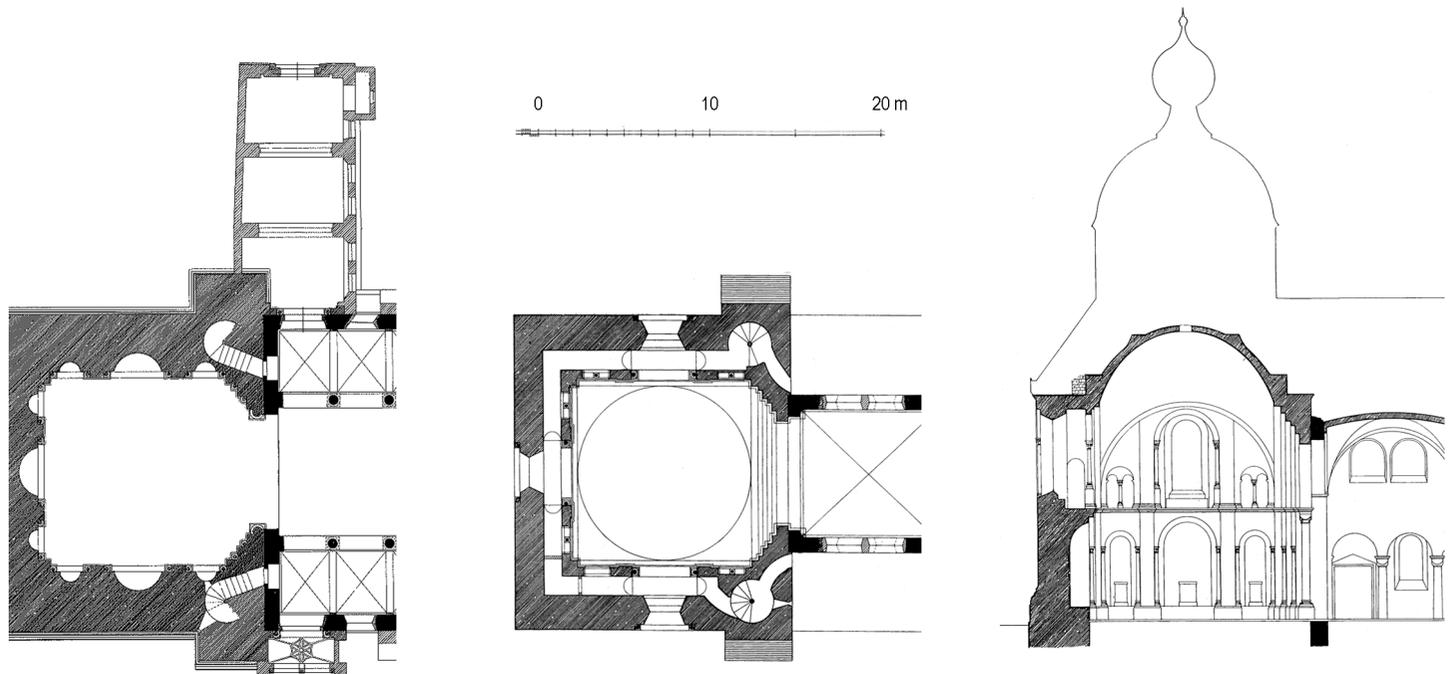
Köln, St. Georg. Westchor, Grundriss Erdgeschoss, Grundriss Laufgangzone und Längsschnitt (1916). Die Stufen zum Westchor fehlen infolge der damaligen Erhöhung des Langhausfußbodens.
